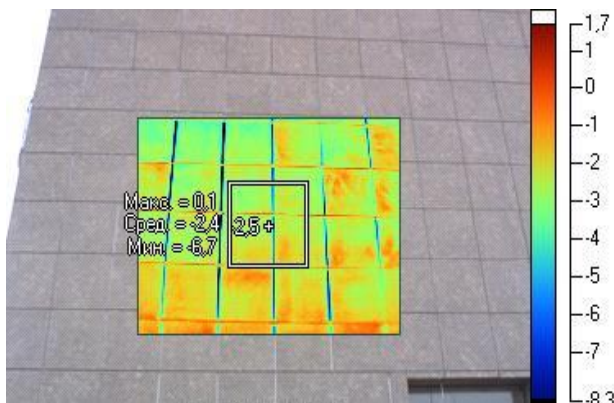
Административное здание каркасного типа с вентилируемым фасадом
